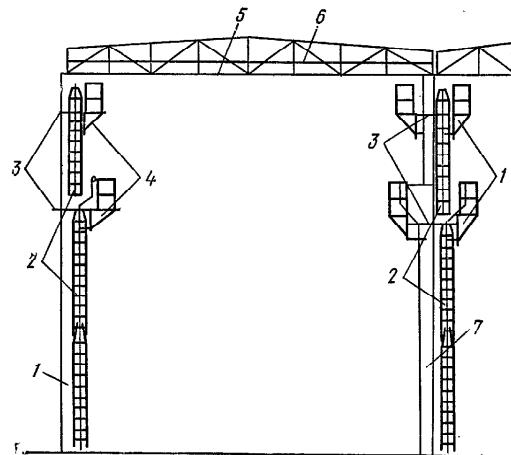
Размещение люлек и лестниц на конструкциях здания:
